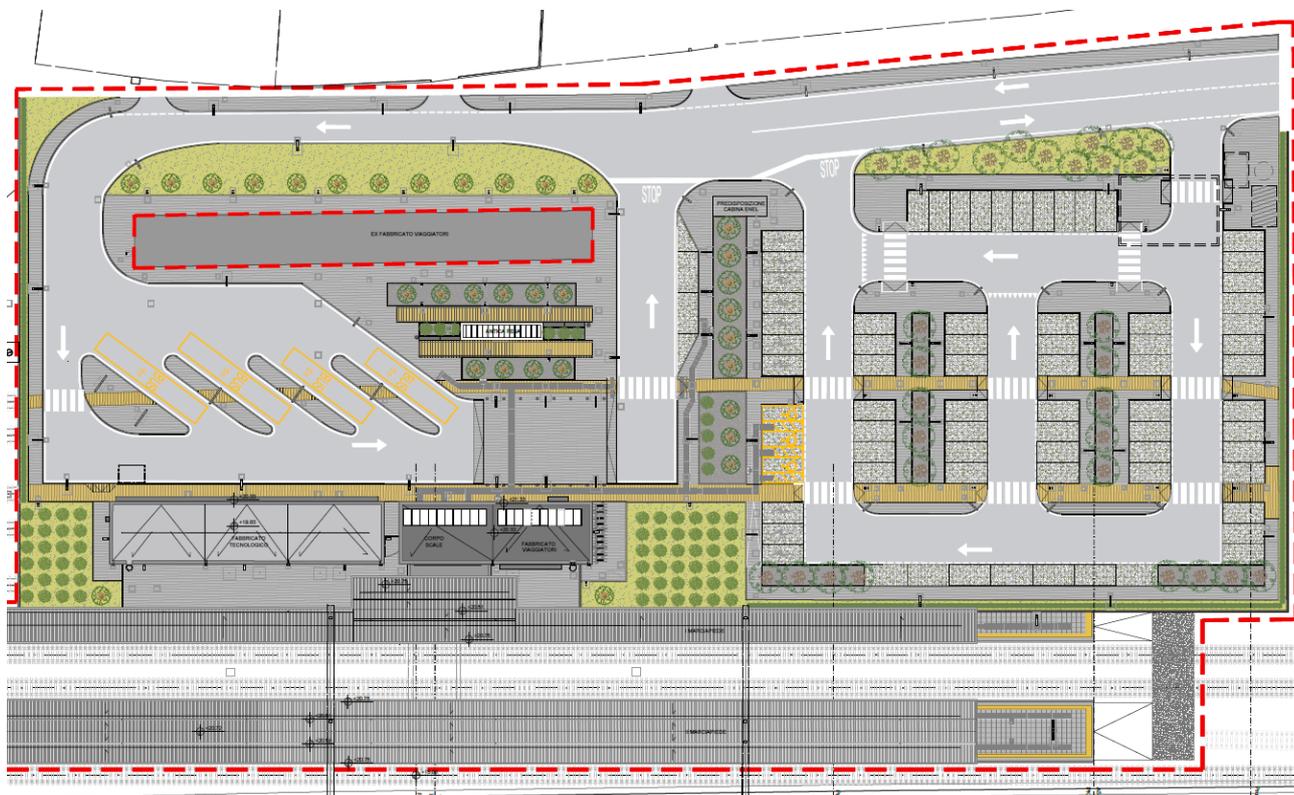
Piazzale di stazione con pavimentazione in masselli autobloccanti
